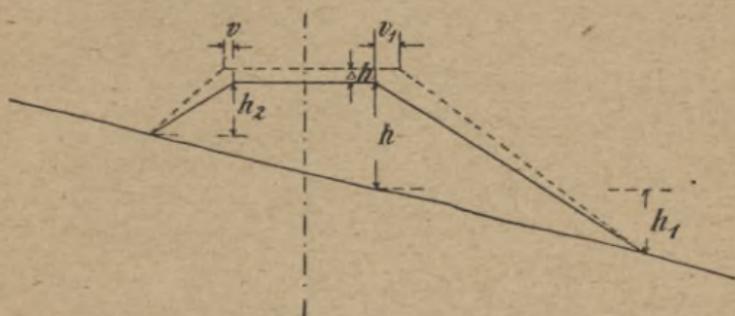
Dammüberhöhung bei stark geneigtem Untergrund.
